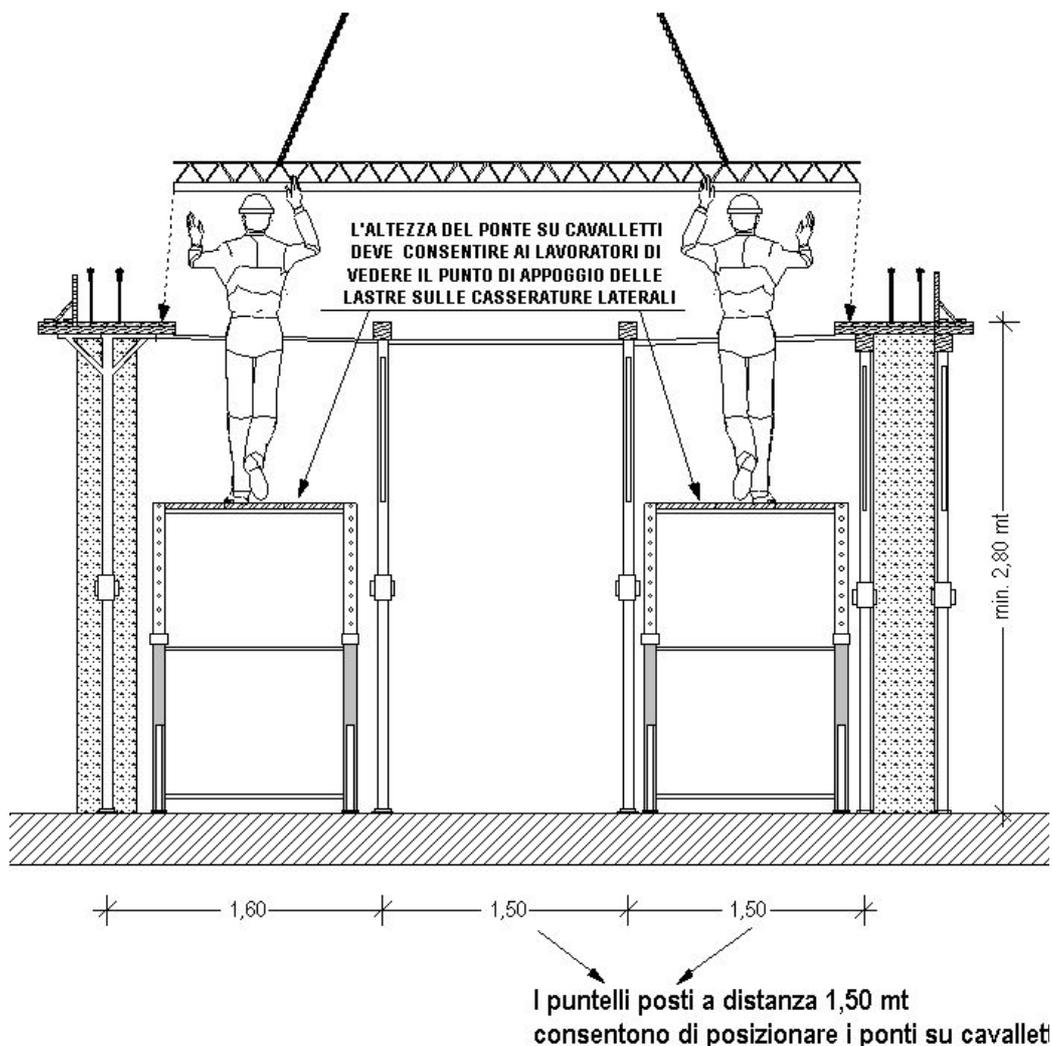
posa prima lastra dal basso con l'ausilio di ponte su cavalletti
